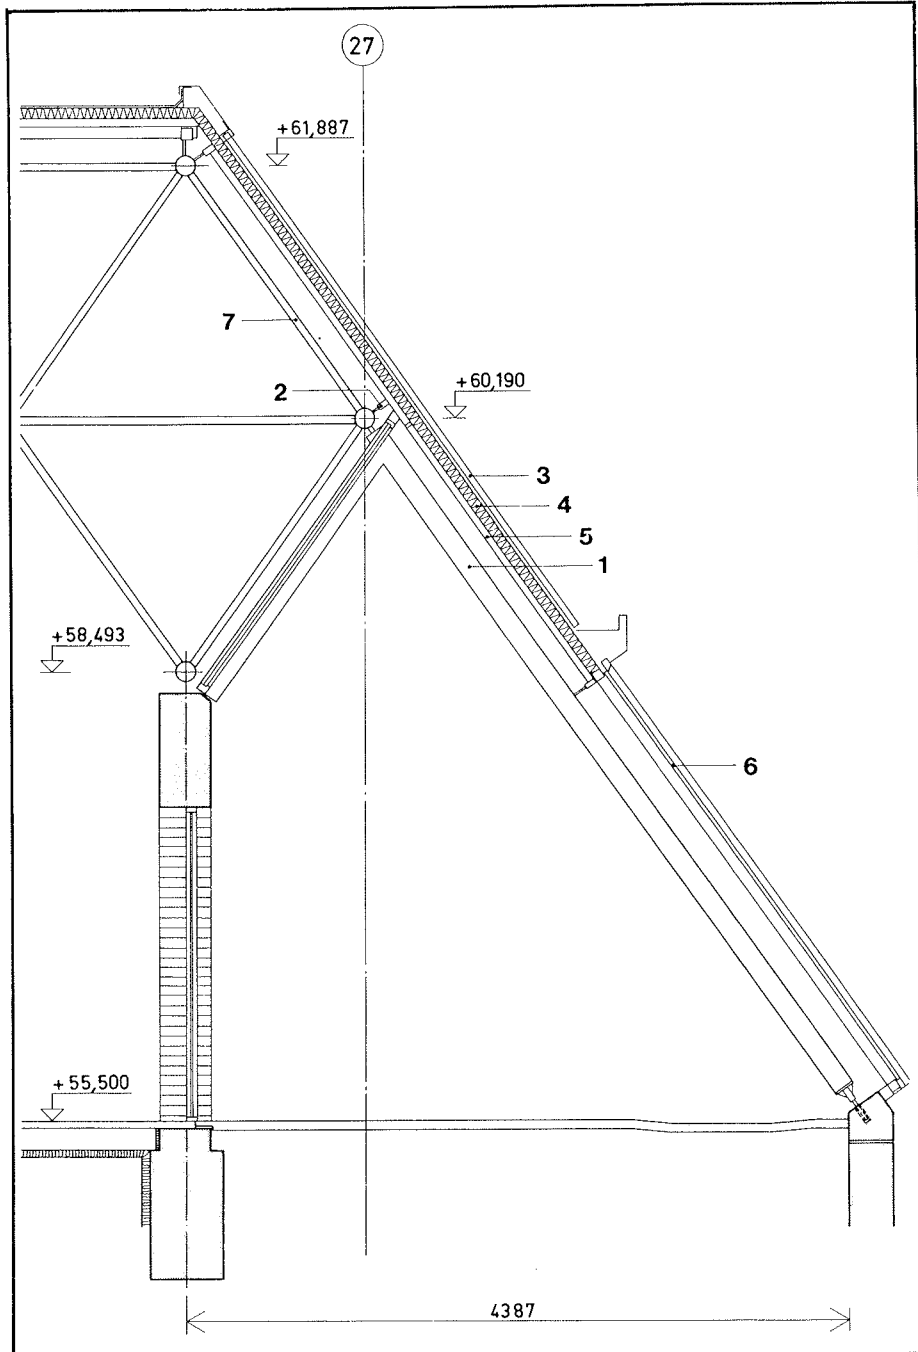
Snit gennem facade, 1:50. 1. Facadebjælker, firkanttrør 150x75x5 mm. 2. Facaderigler, firkanttrør 80x40x4 mm. 3. Cor-Ten stålplader. 4. Mineraluldisolering. 5. Korruerede stålplader. 6. Vinduer i aluminiumrammer. 7. Rumgitter.
